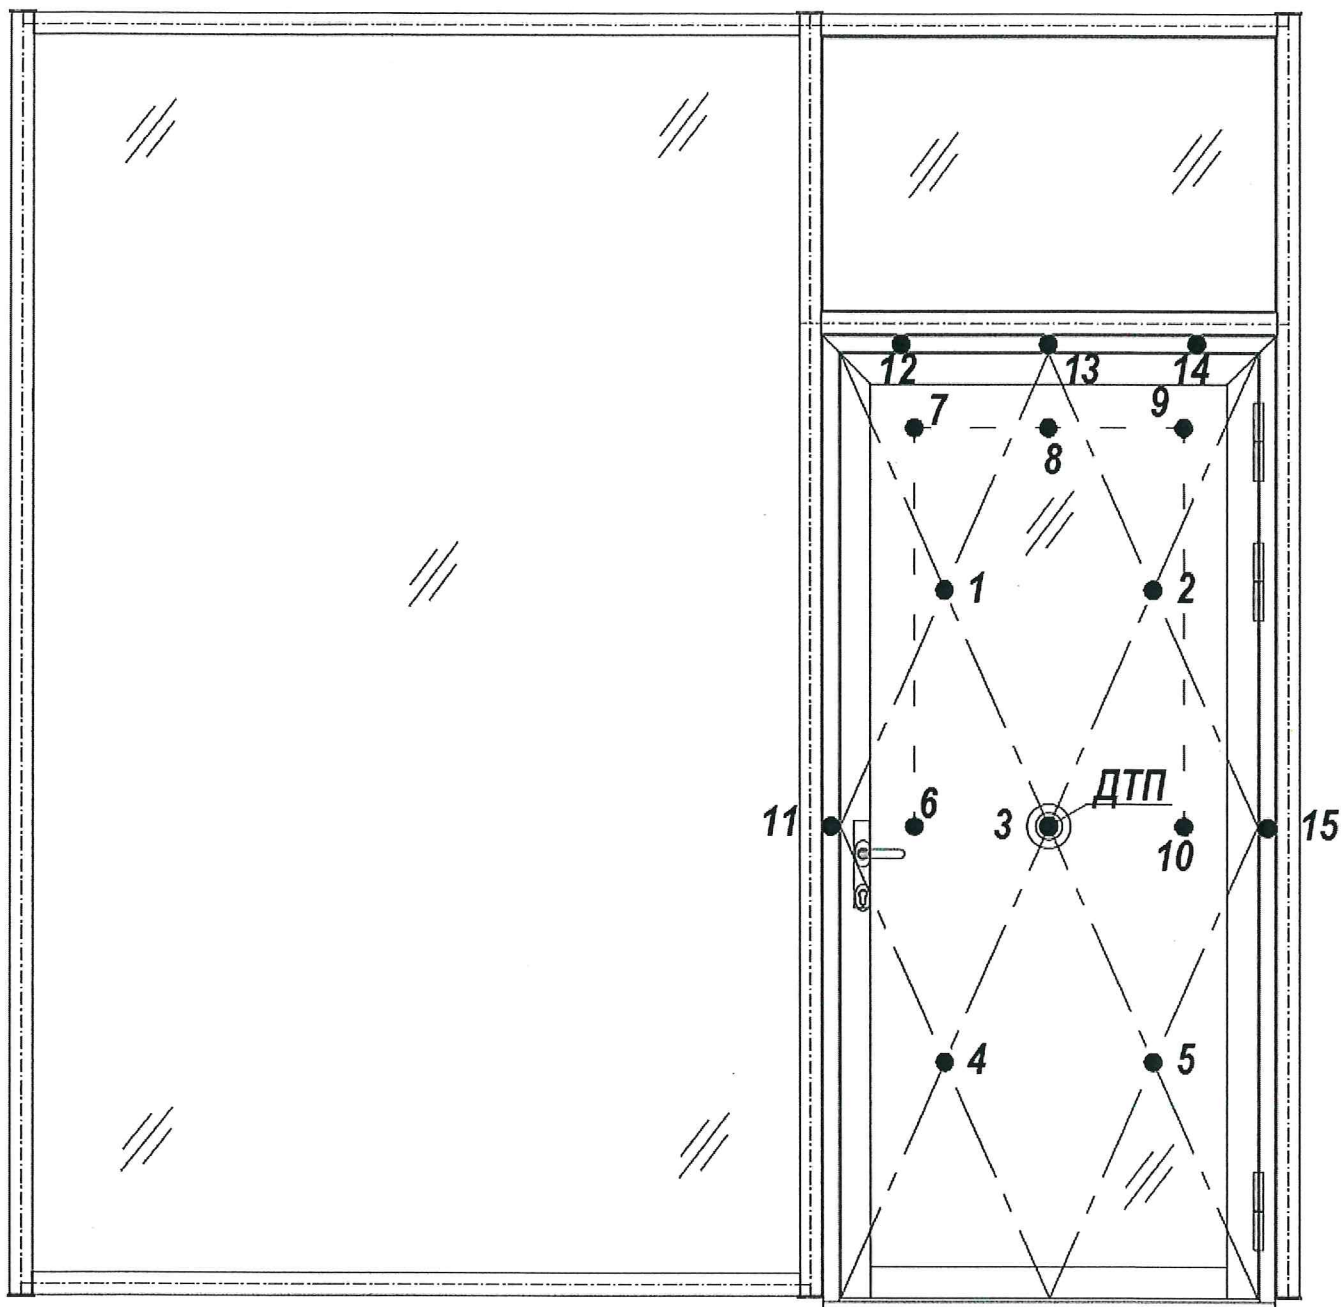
Схема расстановки термопар и ДТП на необогреваемой поверхности образца № 1.
